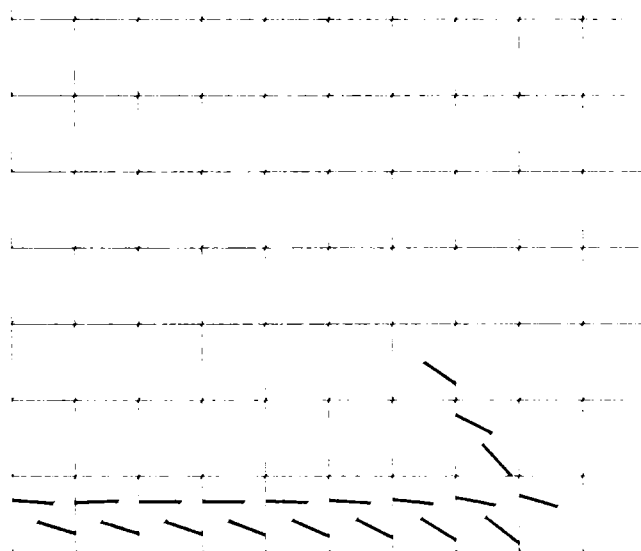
Distribuția fisurilor la rupere pentru elementul ES
